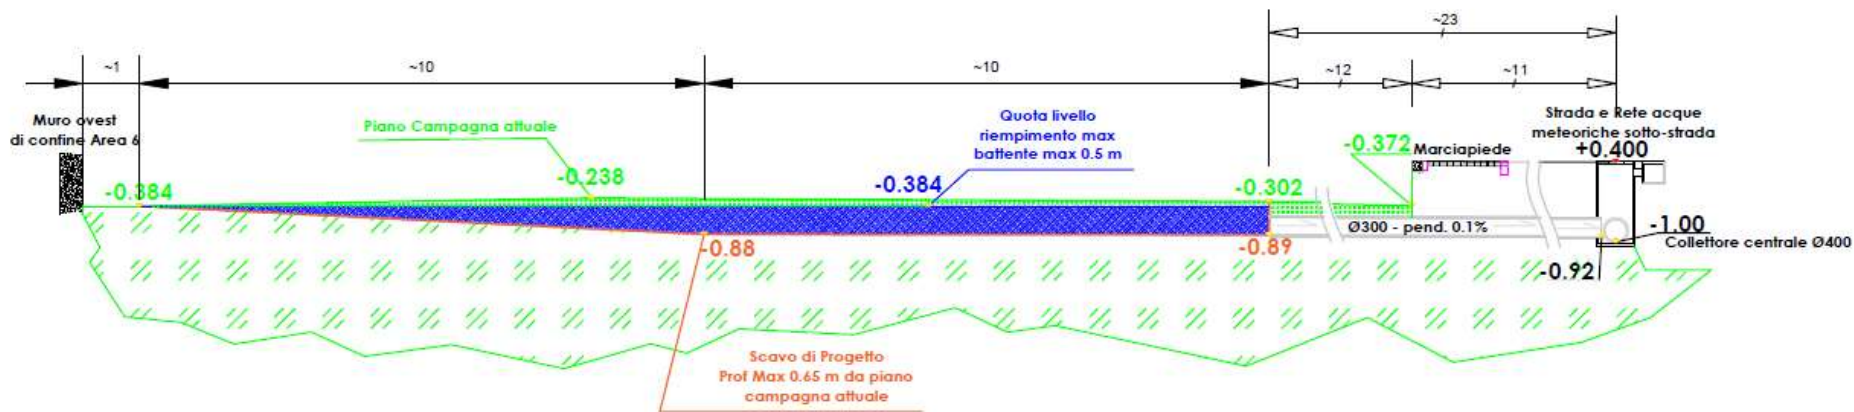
Sezione trasversale indicativa delle quote di progetto dell'invaso di laminazione e della condotta di mandata-scarico di collegamento alla rete di raccolta acque meteoriche
